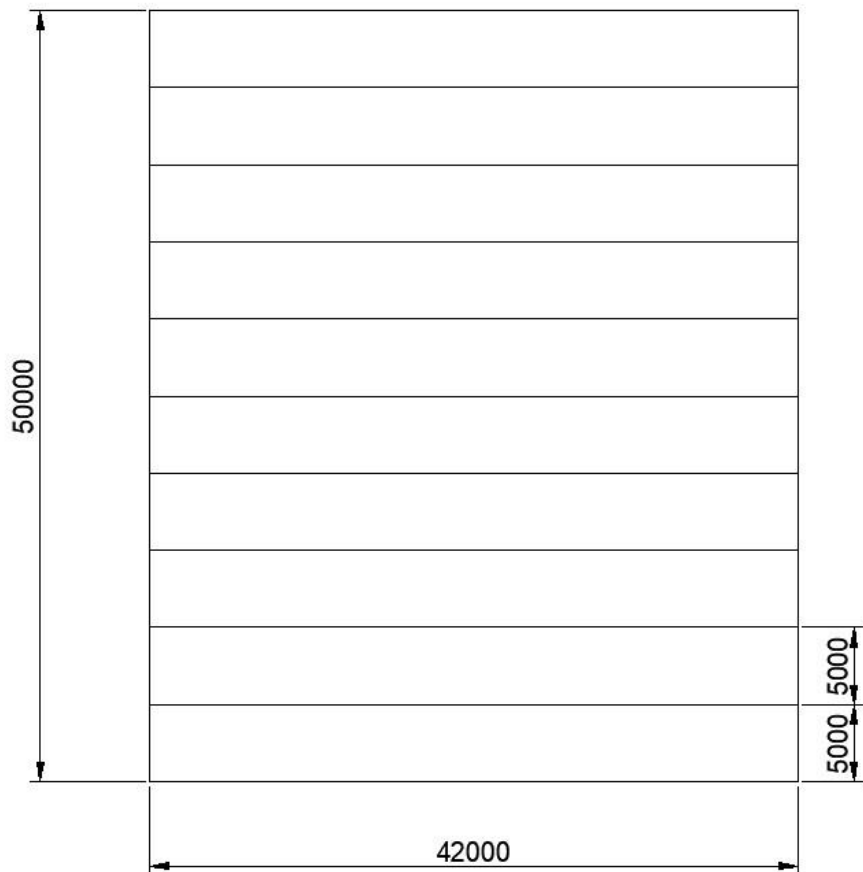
Esquema en planta de los pórticos de la estructura. Fuente: elaboración propia.
